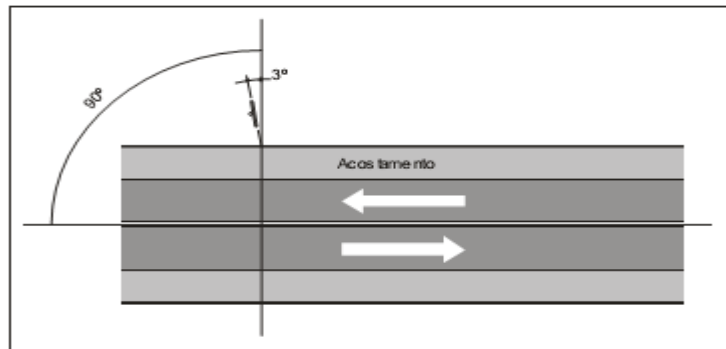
A deflexão do sinal em planta (MT/DNER/IPR)
